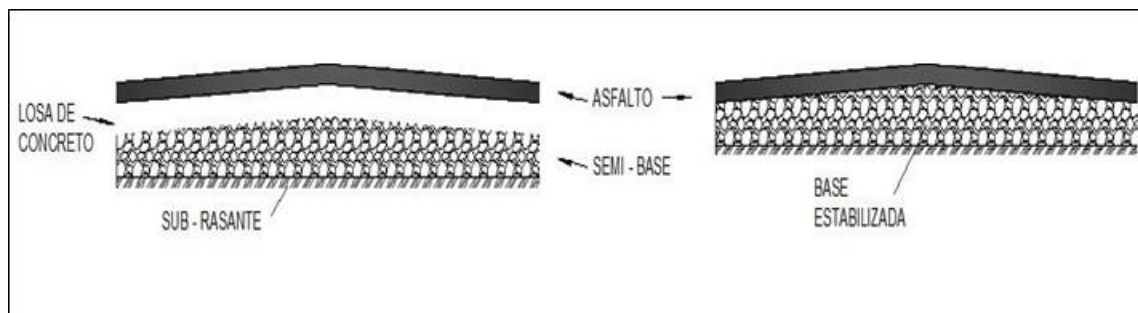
Estructura de pavimento Semirígido - (Salazar Rodríguez, 2018)
